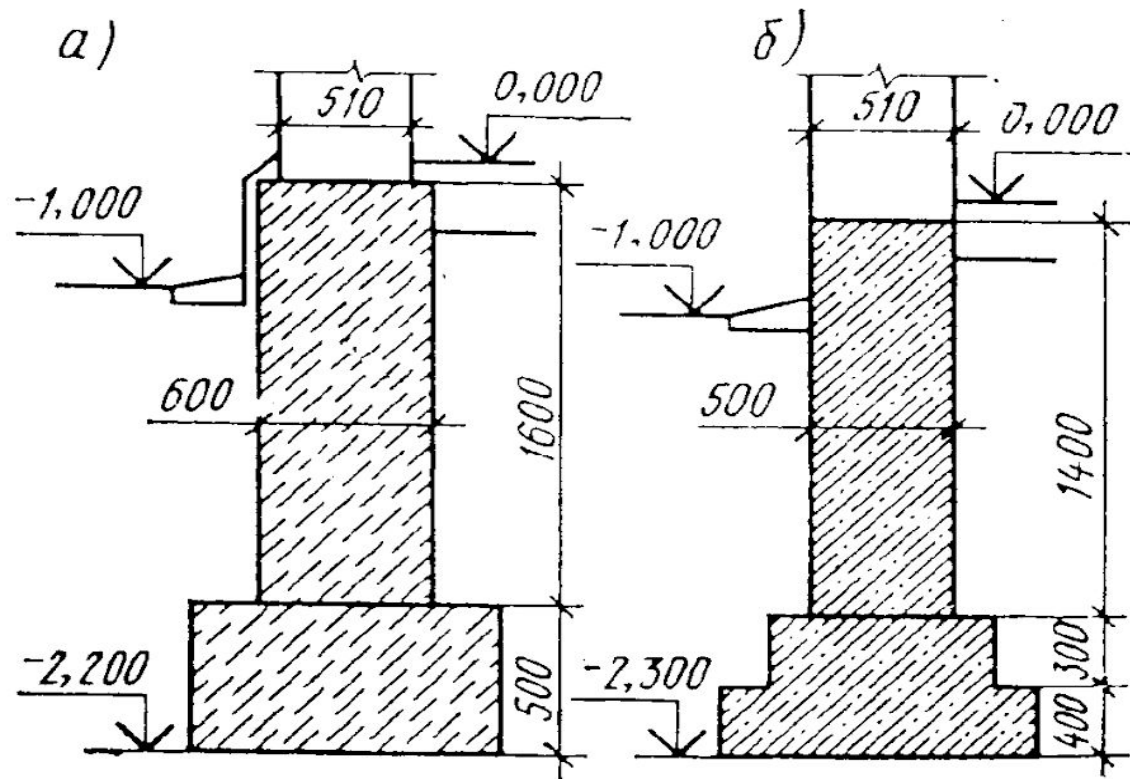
Ленточные монолитные фундаменты под кирпичную стену:
